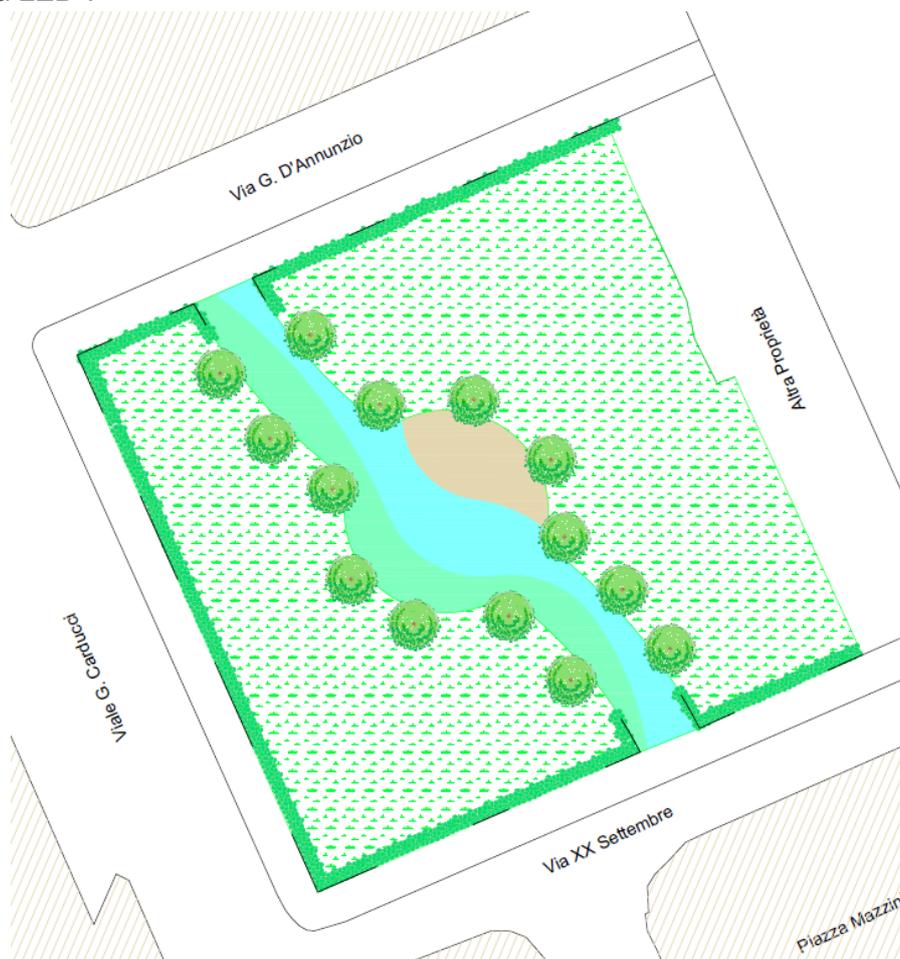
Estratto da "Planimetria generale stato di progetto" allegata alla D.C.C. n. 68/2022
